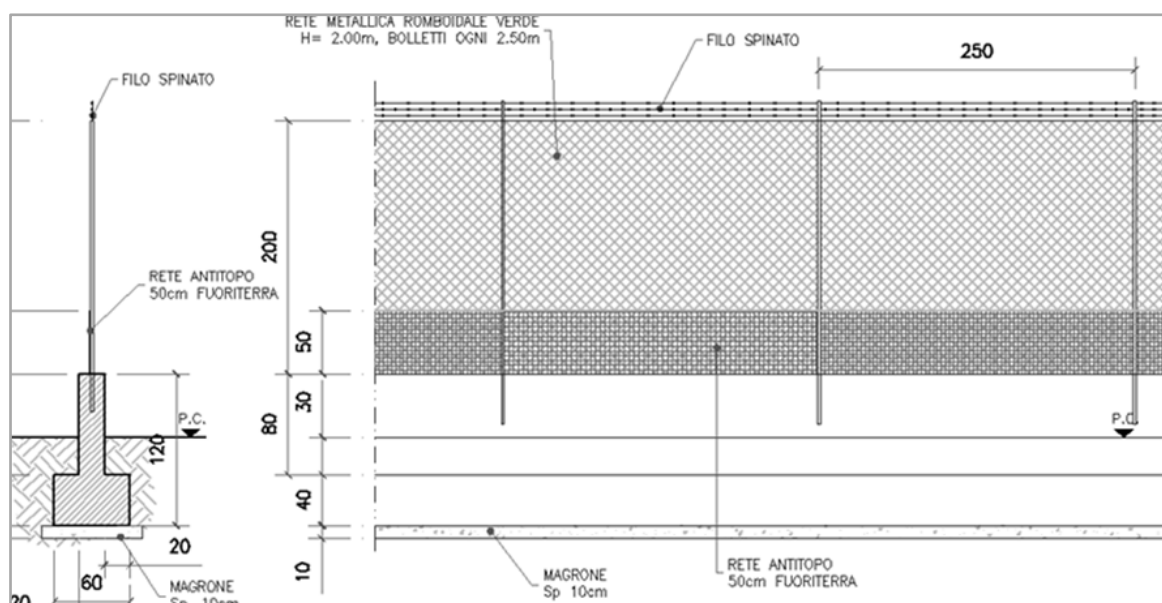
Prospetto e sezione tipologici della recinzione perimetrale
